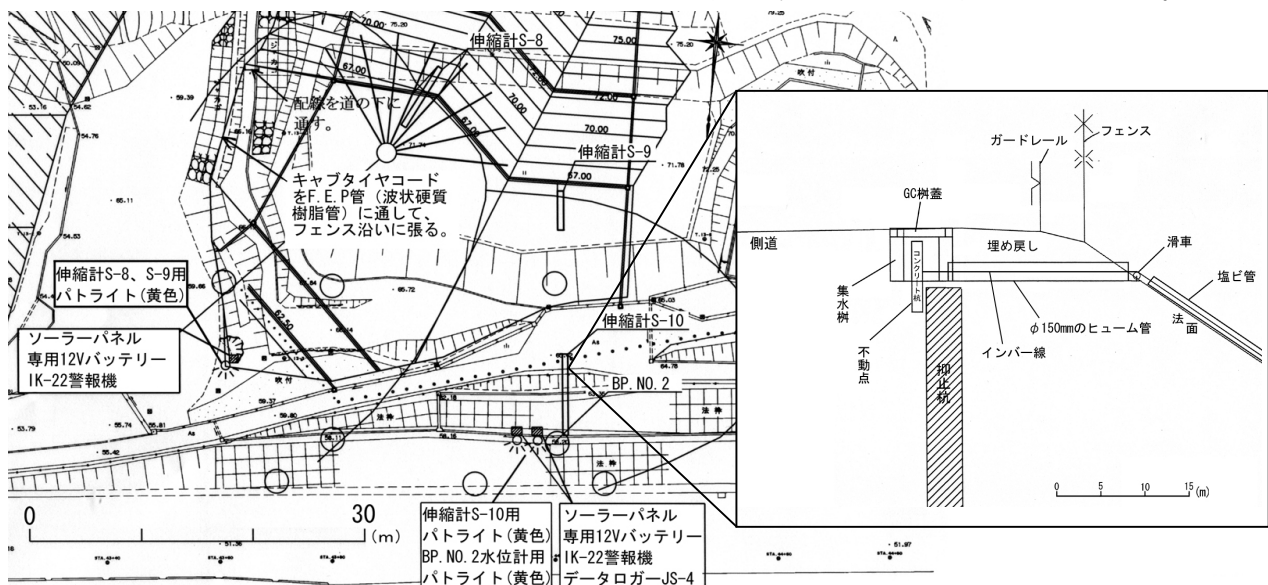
警報装置設置平面図と伸縮計 S-10 設置横断面図
